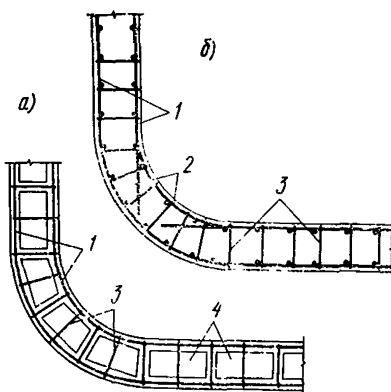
Примеры армирования углов стен каркасами (а) и сетками (б)
